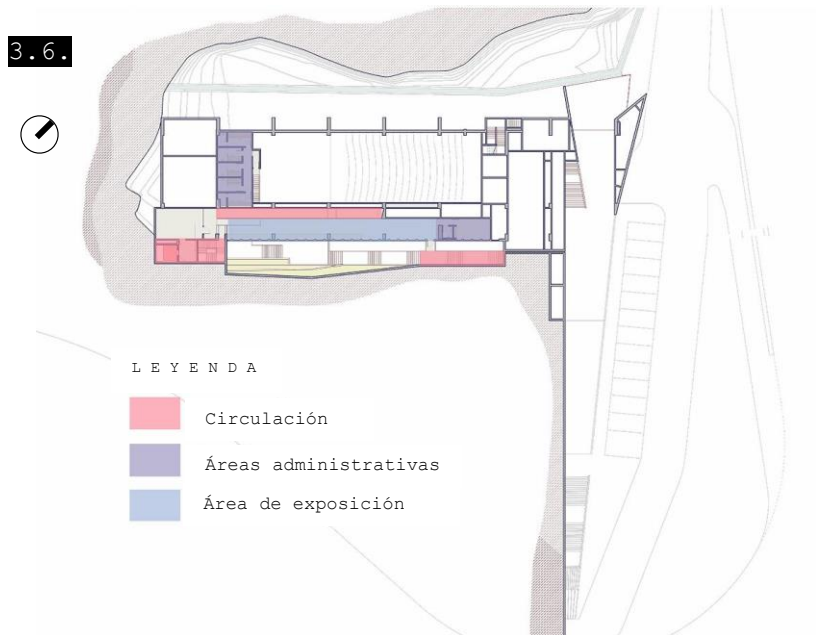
Planta cubierta mirador. (redfundamentos, 2014)
